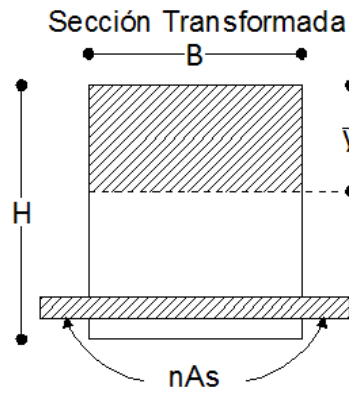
Estado II – Esfuerzos elásticos y sección fisurada
